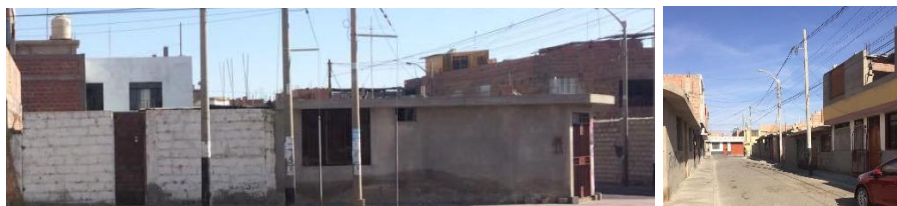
Vista de las viviendas aledañas y su sistema constructivo
